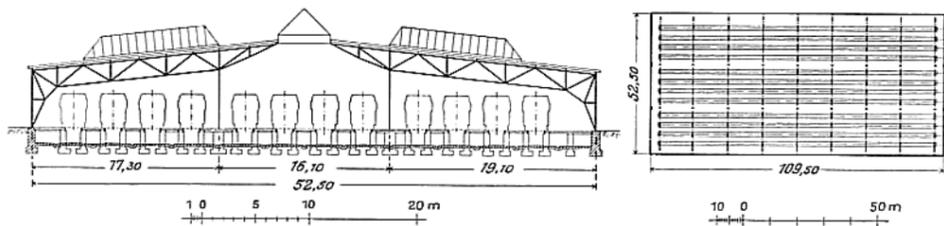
Revisionshalle auf Betriebsbahnhof Grunewald.
